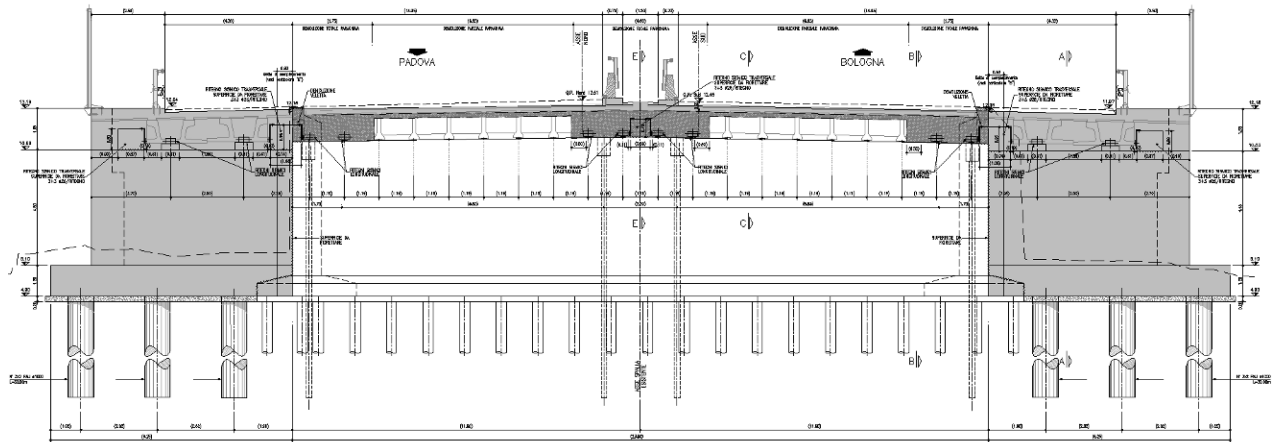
Prospetto spalla con notazione ritegni trasversali
